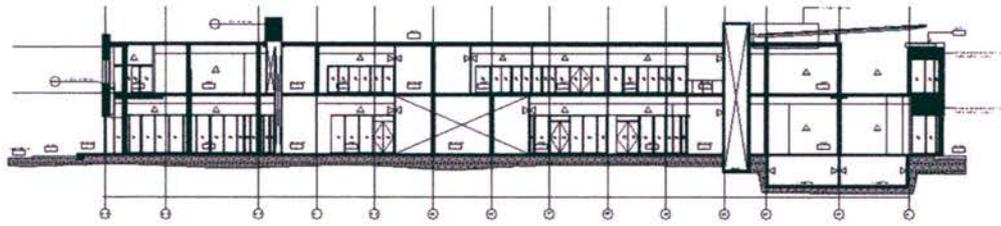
แสดงภาพ ELEVATION C
